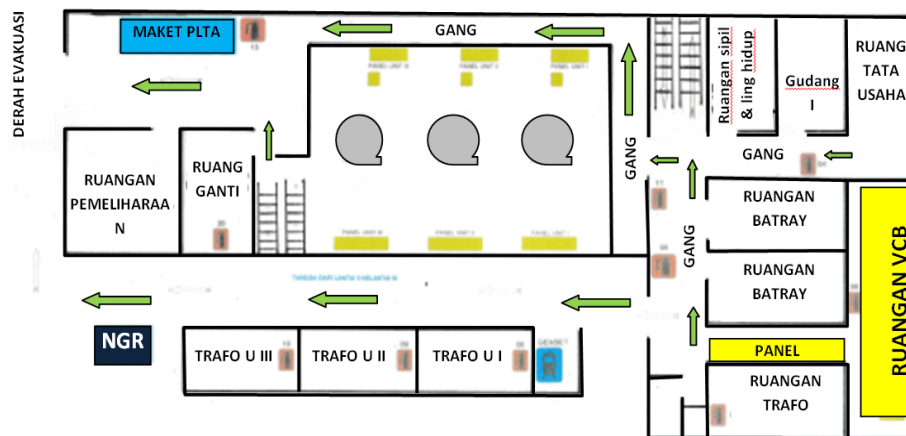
Bangunan Sentral PLTA Batang Agam Lantai I
